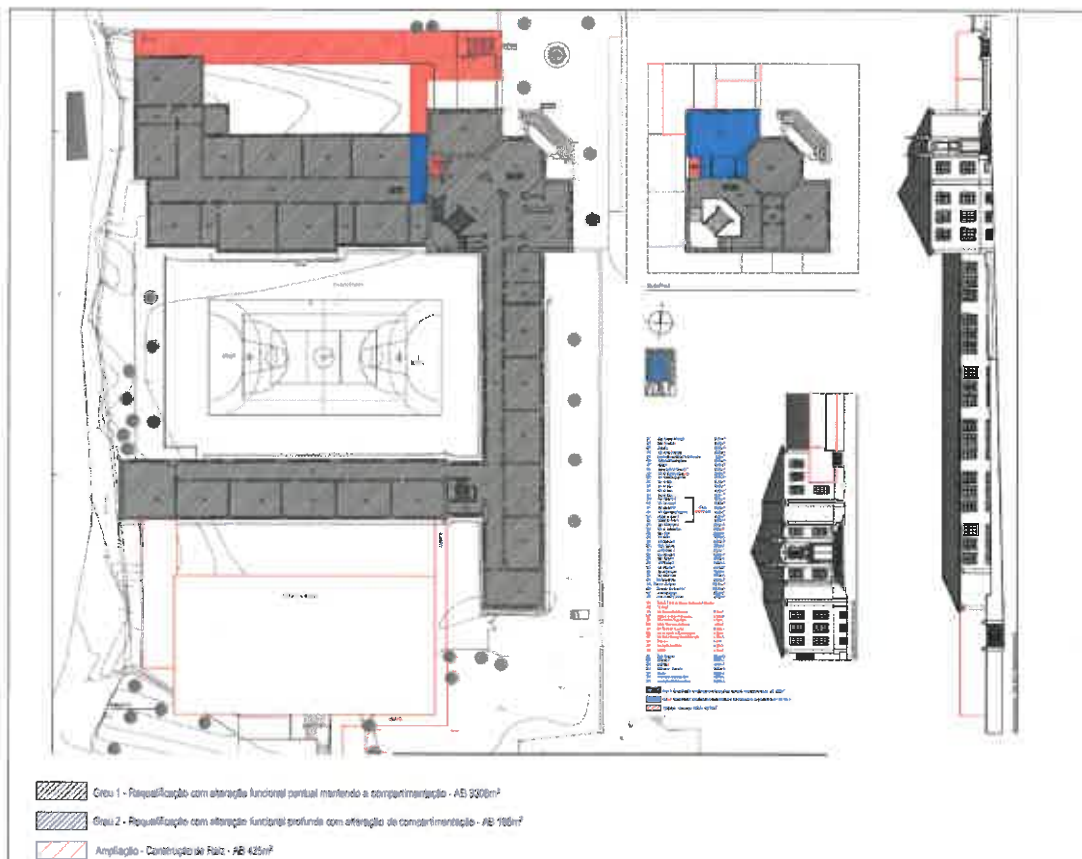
| Intervenção proposta – Planta nível 1 e 2 Edifício Principal + Alçados Nordeste e Nascente
